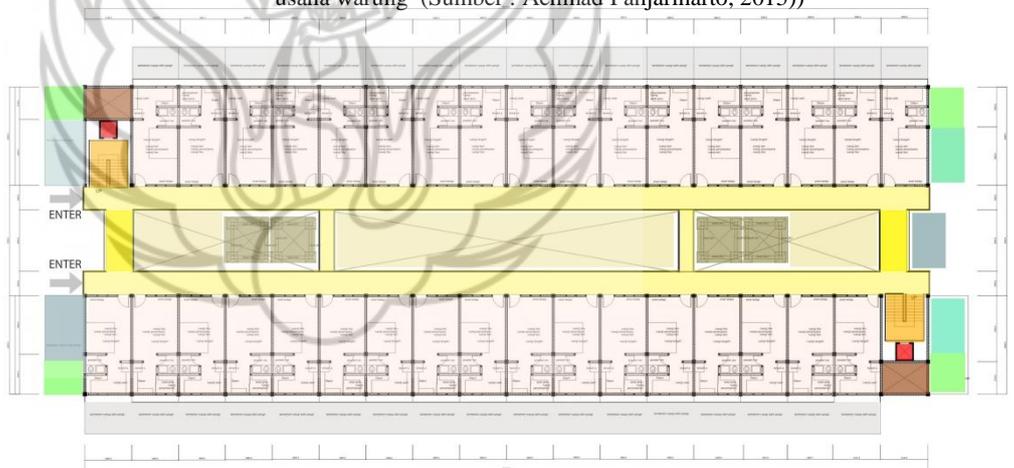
Zona unit tipe 18, Blok H dengan penggunaan sebagai tempat tinggal dan usaha jahit sarung tangan bayi (Sumber : Achmad Fahjariharto, 2015))
